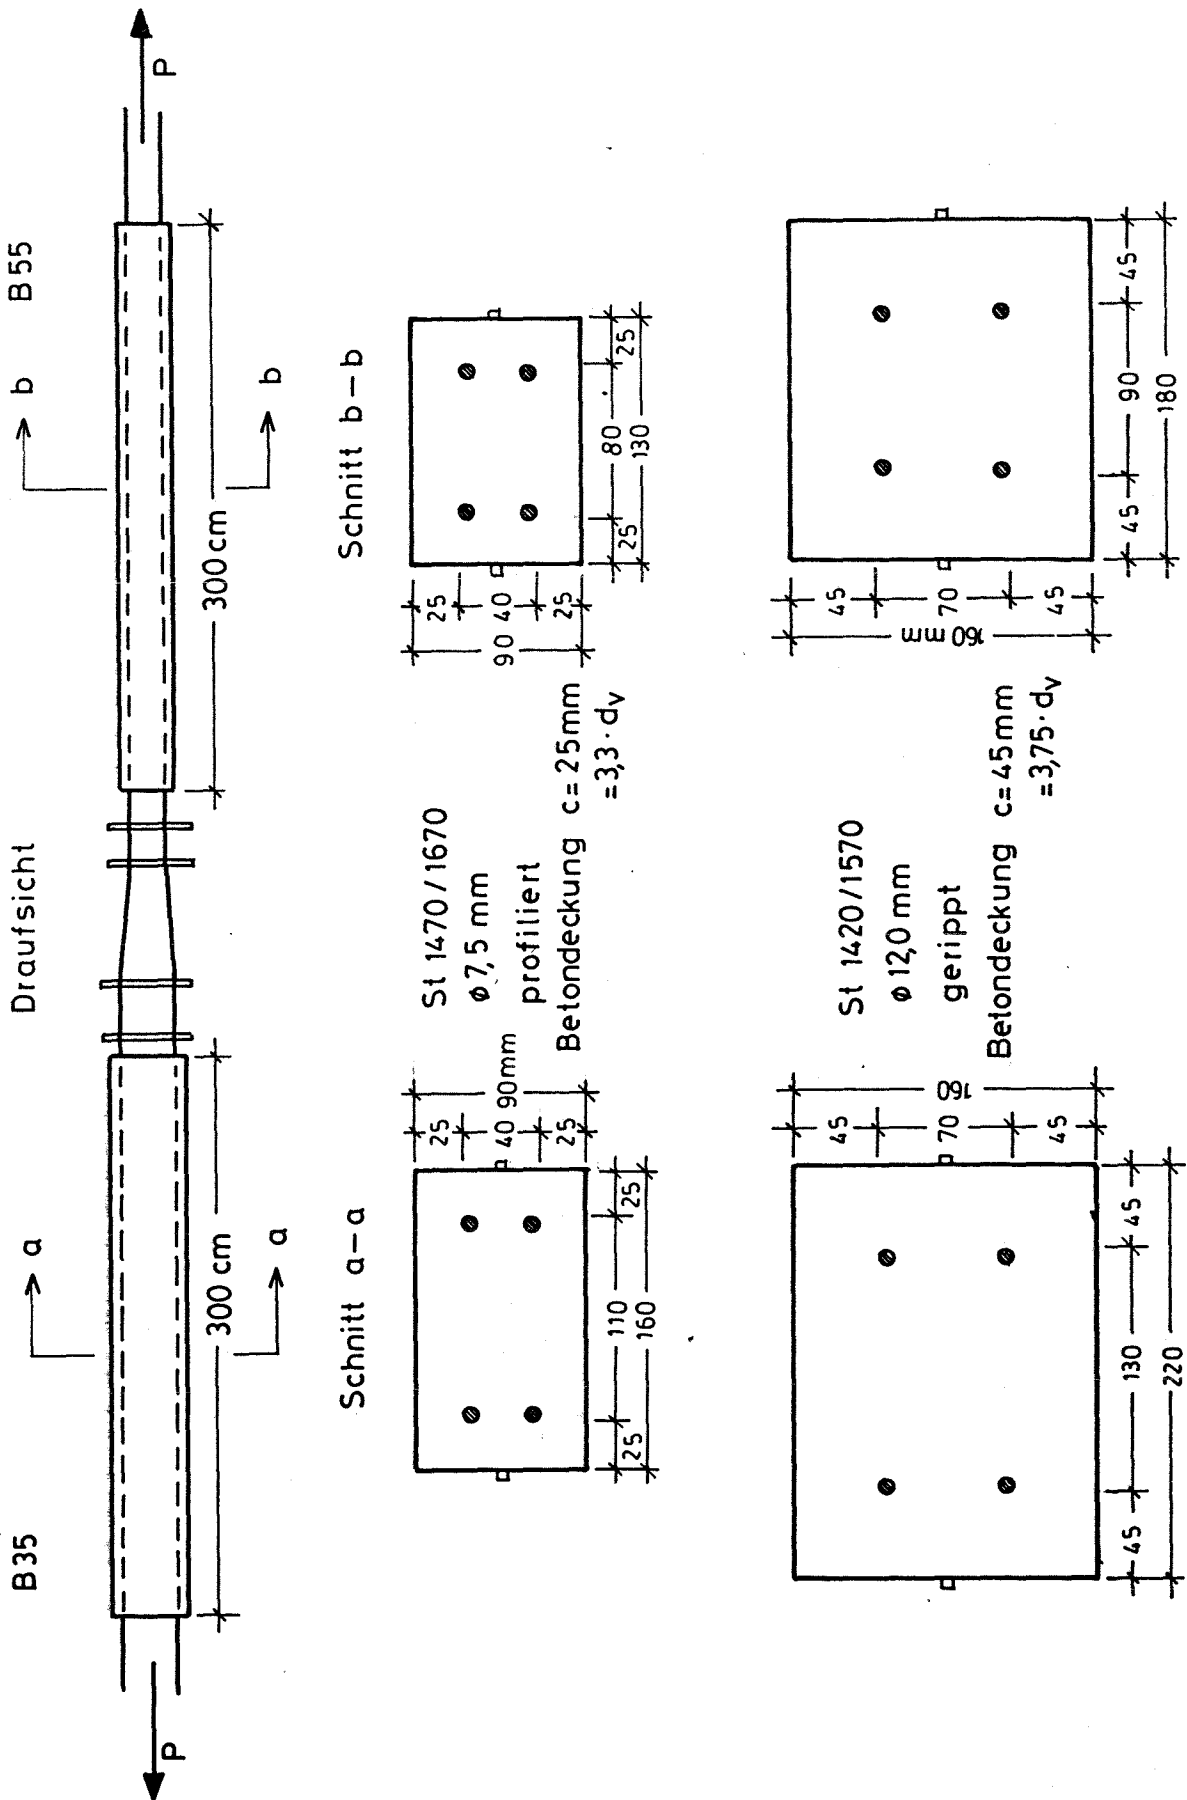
Versuchsanordnung und Abmessungen der Balken der Serie 2 mit vergrößerter Betondeckung
